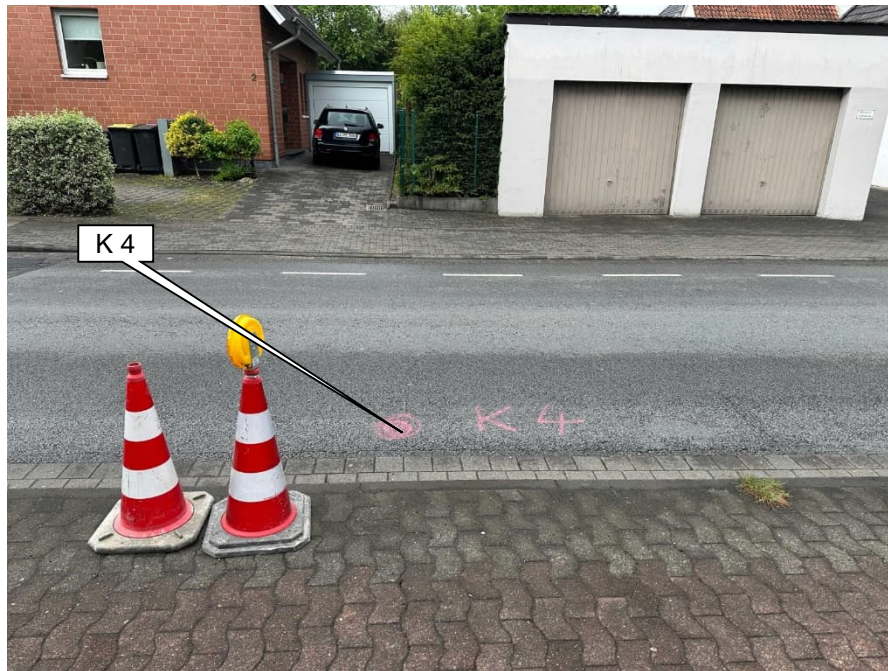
Blickrichtung ~ SW; Bereich der Bohrung K 4 (Markierung)
